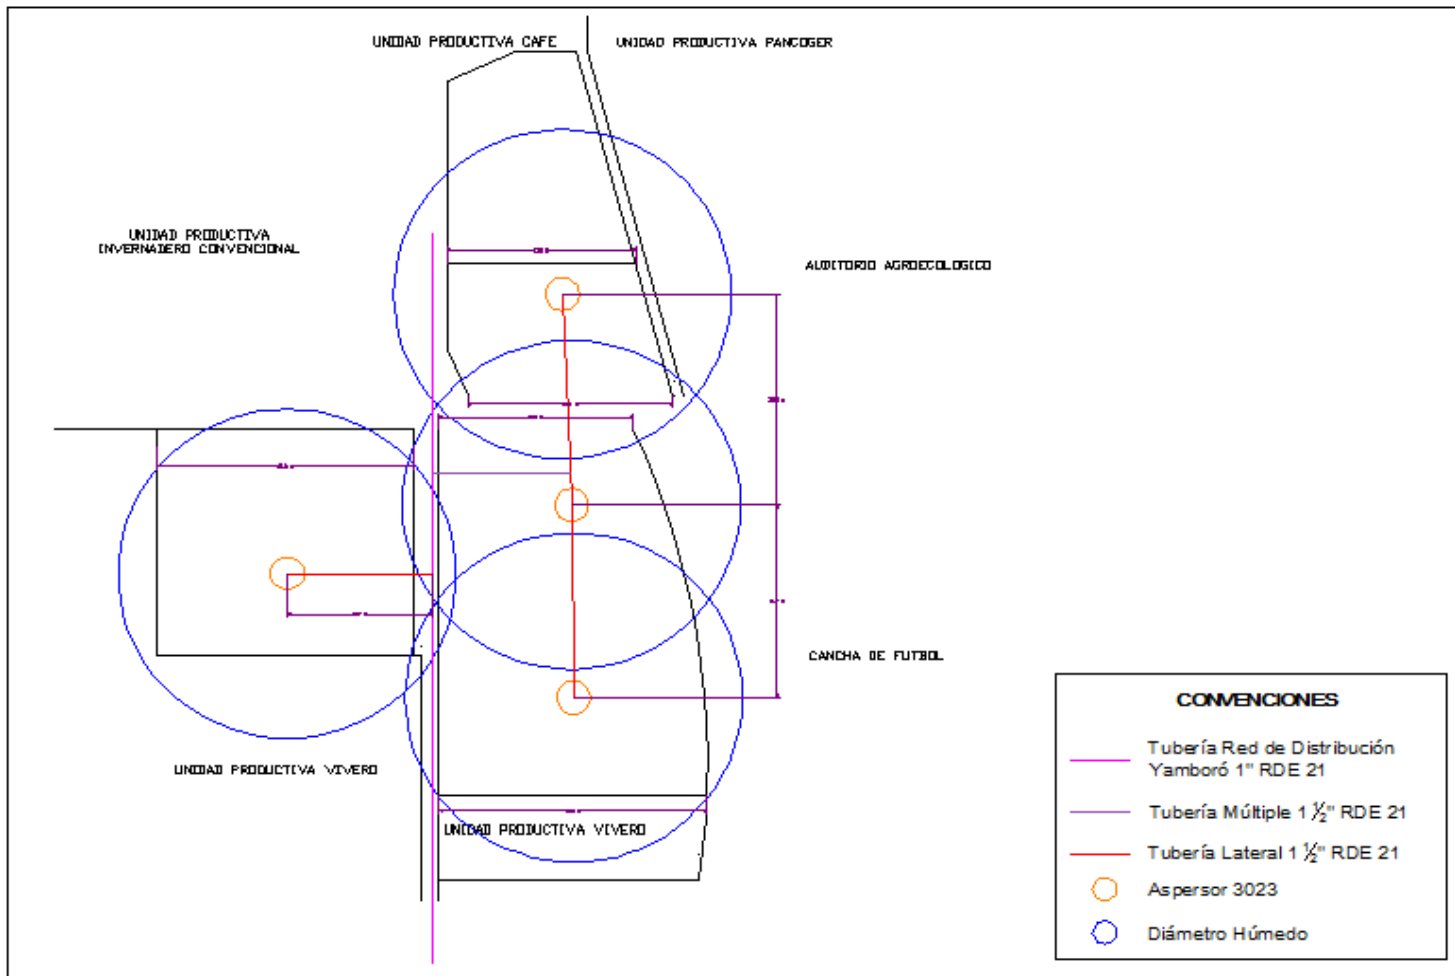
Vista en planta sistema de riego por aspersión, plantas medicinales
